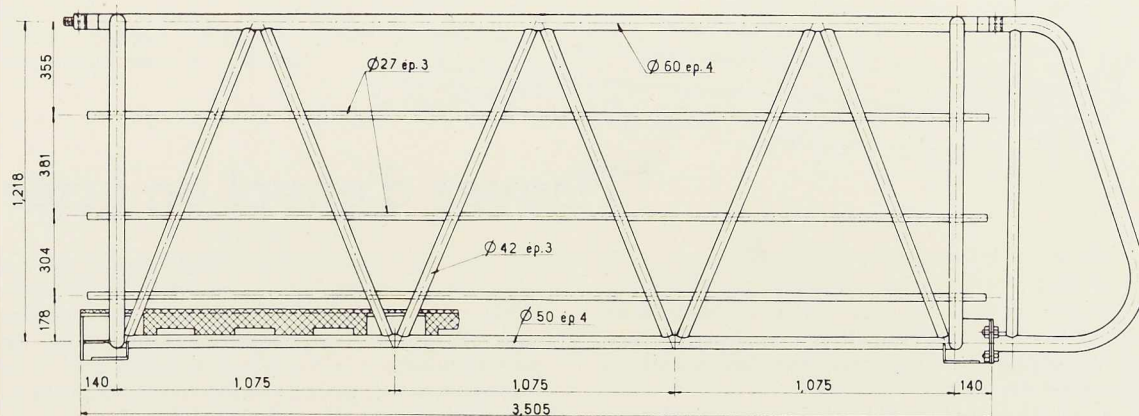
Détail d'une passerelle en tubes d'acier. Les assemblages sont réalisés par soudure. Le platelage est constitué par des tôles striées, raidies par des tubes placés en croix.
